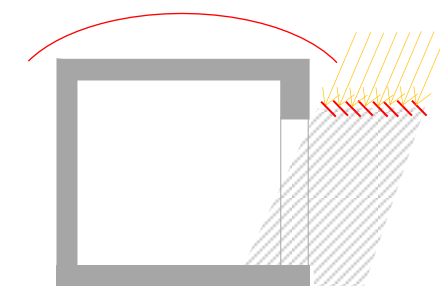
Sistema de persianas horizontales de protección solar. Fuente: Elaboración propia.
